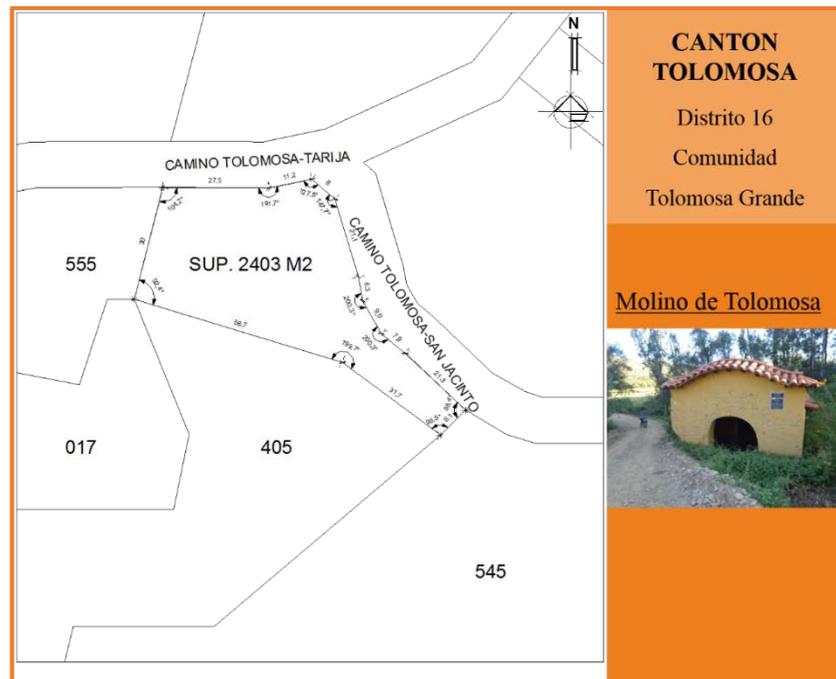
Planimetría del proyecto.Tolomosa.
